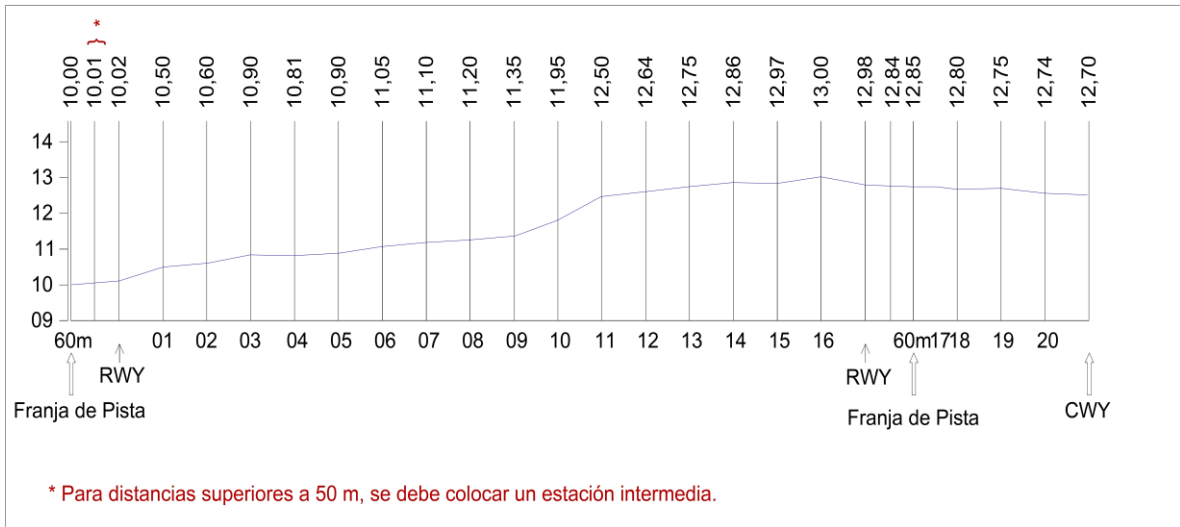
Información contenida en la Planta del Perfil Longitudinal Acotado.
